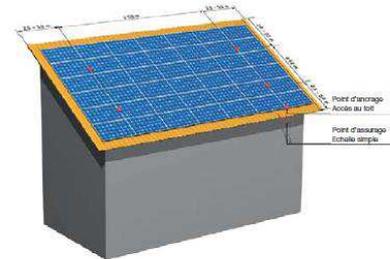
Exemple de protection contre les chutes avec points d'ancrage individuels dans le cas de panneaux solaires praticables (p. ex. sur un toit à un versant)
